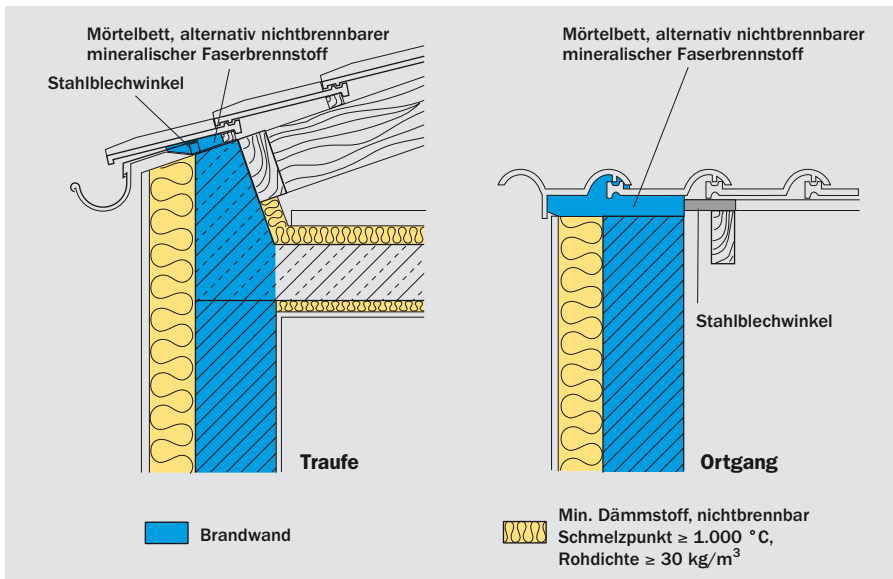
Dachanschlüsse – Traufe, Ortgang – bei Gebäudeabschlusswänden bei Grenzbebauung (Beispiele)
